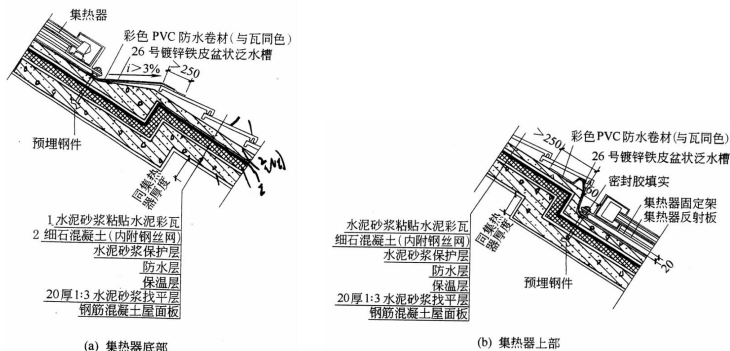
2 真空管集热器镶嵌屋面安装细部构造示意
